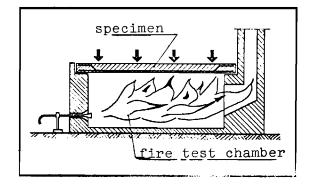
Brandkammer für Deckenprüfungen (Schema) Fig. 21. Fire test chamber for the testing of flaors (diagrammatic) Fig. 21. Chambre pour l'essai aux plafands
